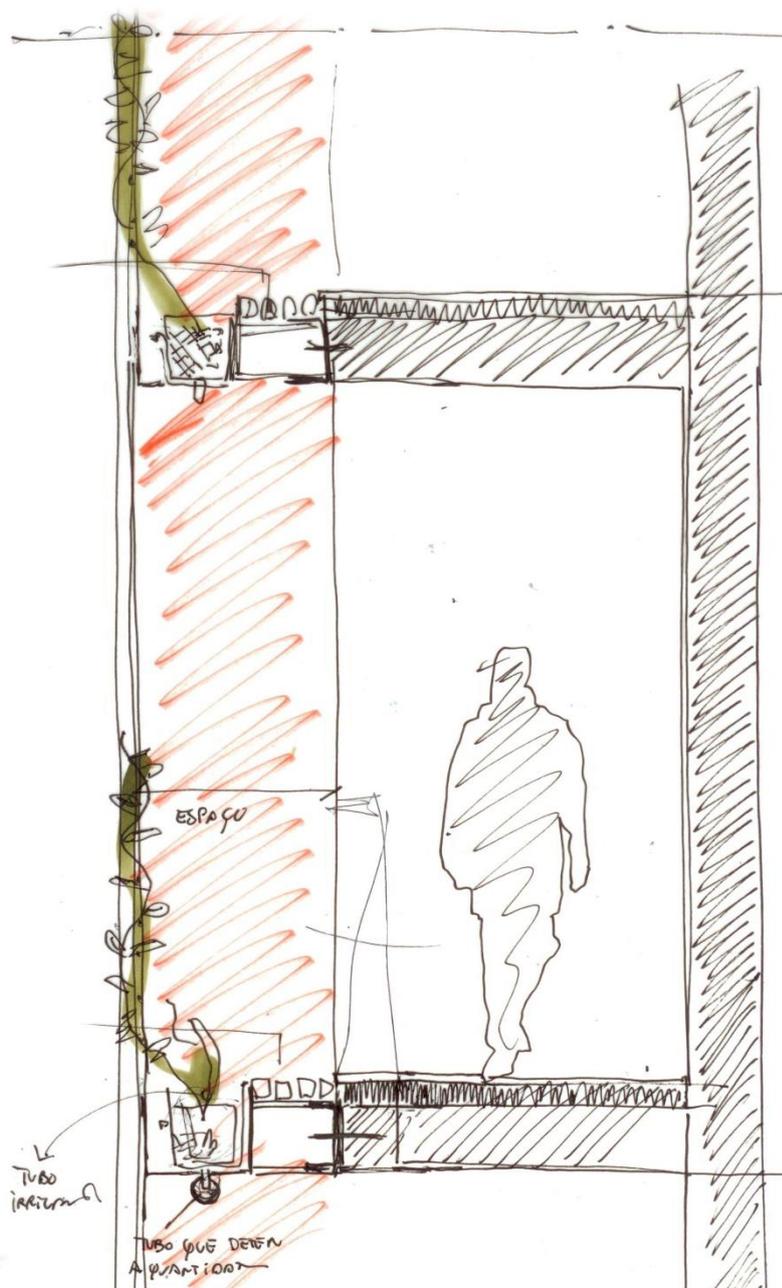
Esquízo do corte construtivo da solução a implementar nas fachadas do bairro Alfredo Bensaúde
